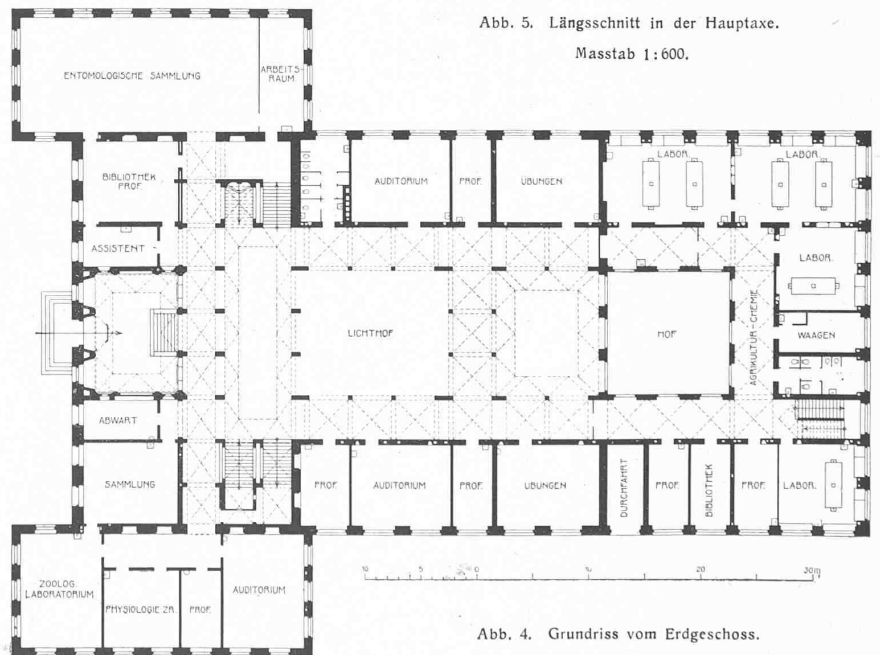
Grundriss vom Erdgeschoss.
